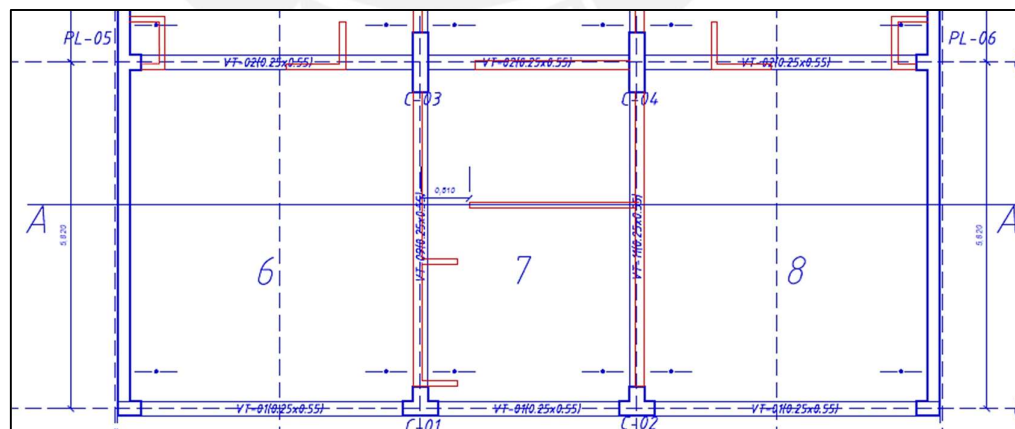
Plano en planta losa aligerada X-X ejes A-F/2-3
